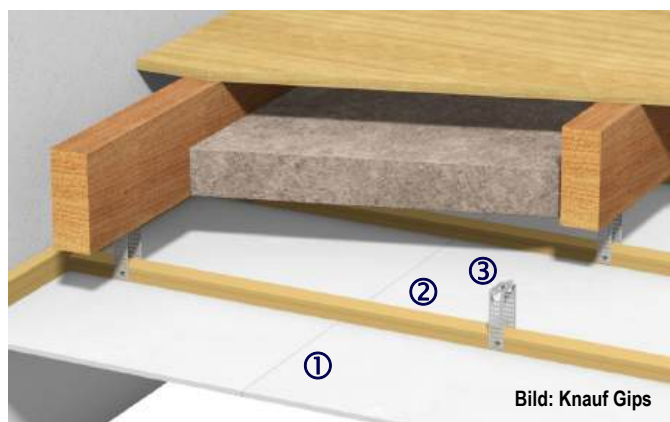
Holzbalkendecke mit einer Unterdecke aus Gipsplatten. Die Unterkonstruktion besteht aus Holzlatten, die mit Direktabhängern an der Balkenlage verankert sind.
